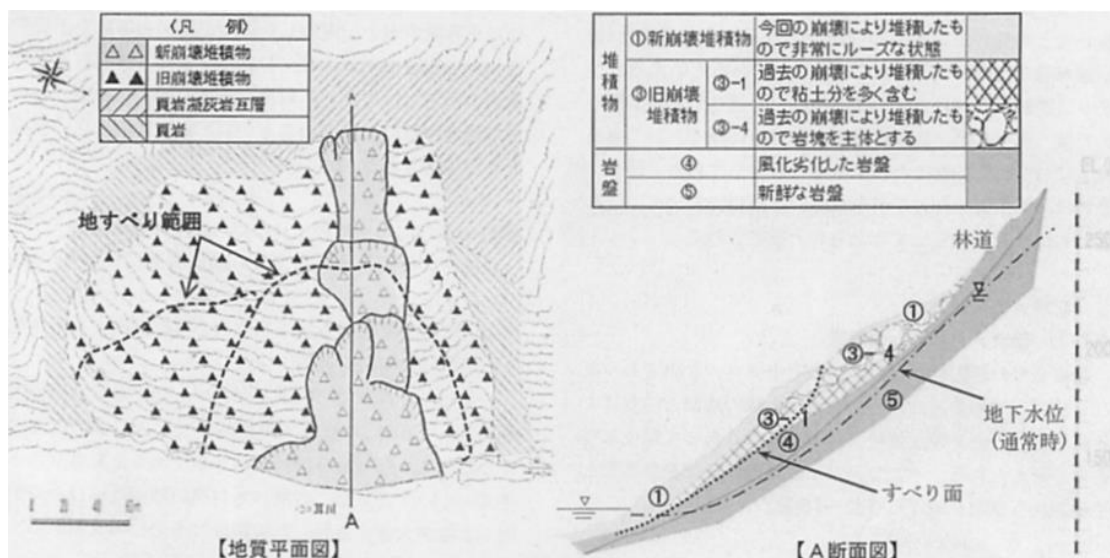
当該斜面の地質平面図と断面図⁸⁾
